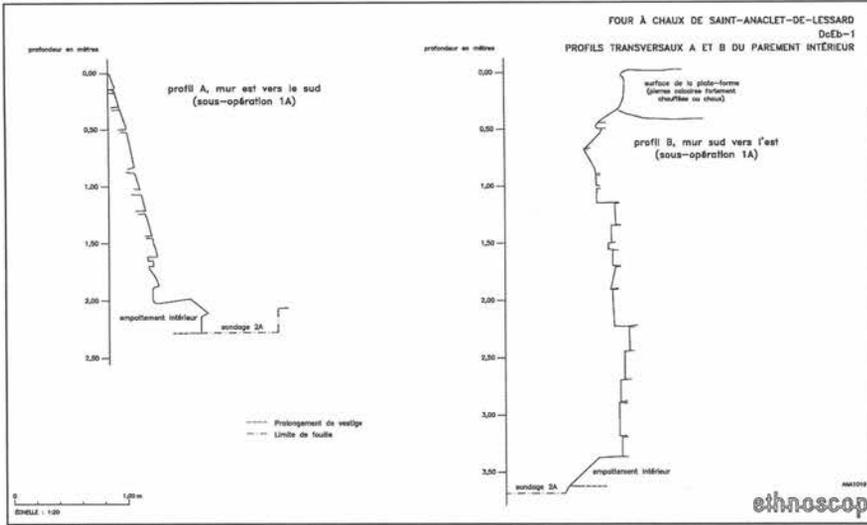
Profils transversaux A et B du parement intérieur du four à chaux
